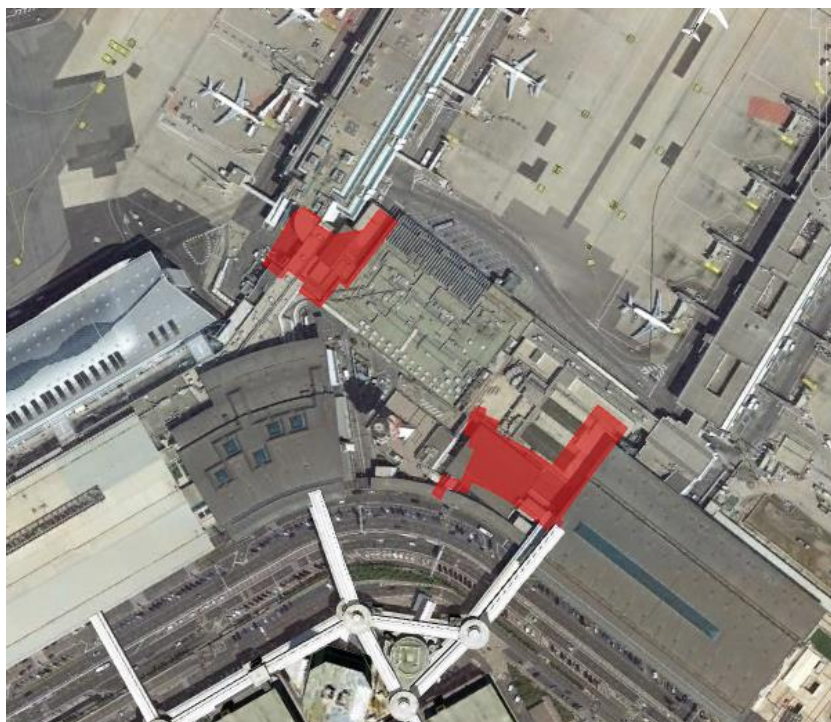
Rappresentazione dell'area di cantiere Stralcio 3 e 4
